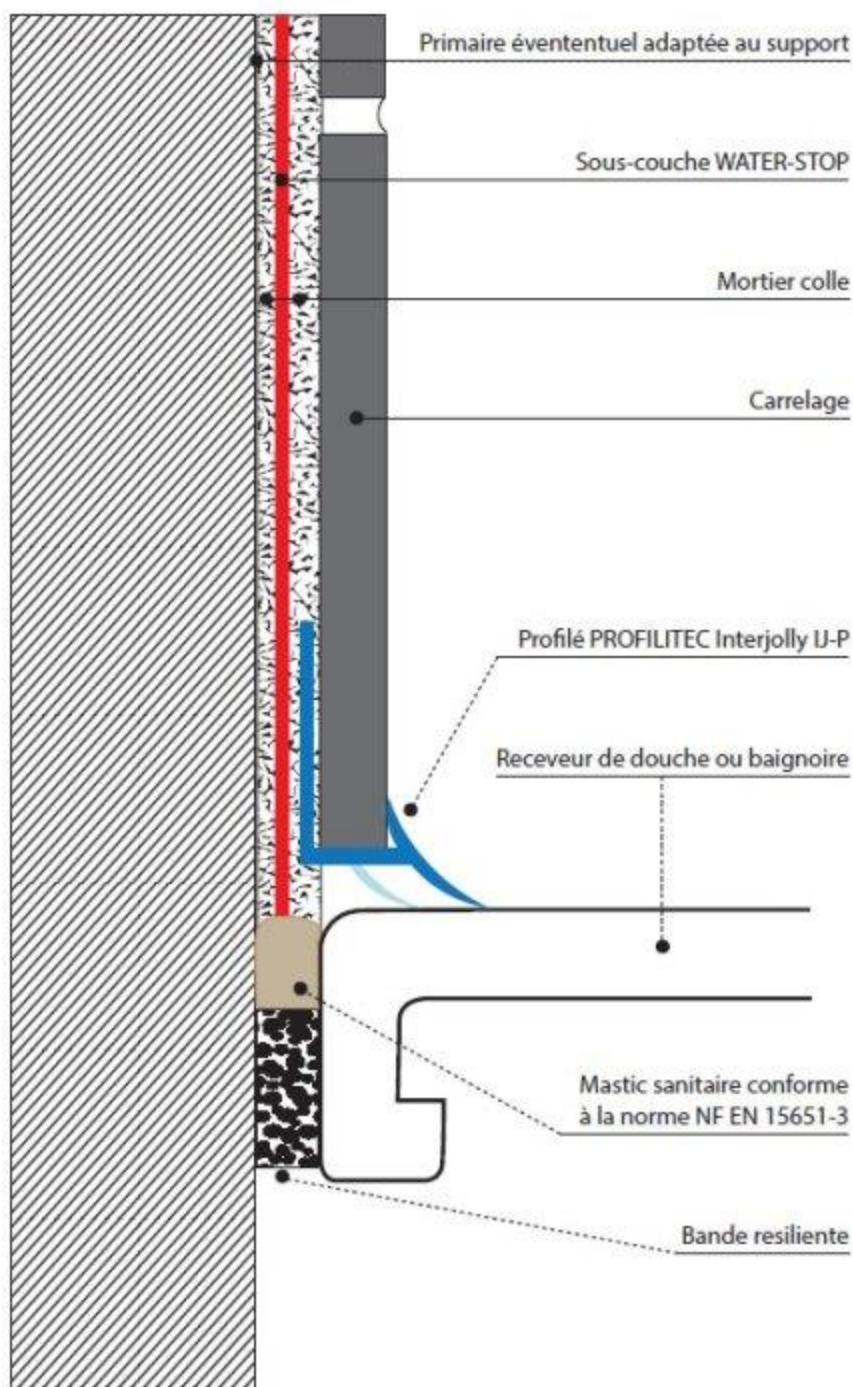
Traitement de la jonction au niveau d'un receveur de douche ou d'une baignoire
